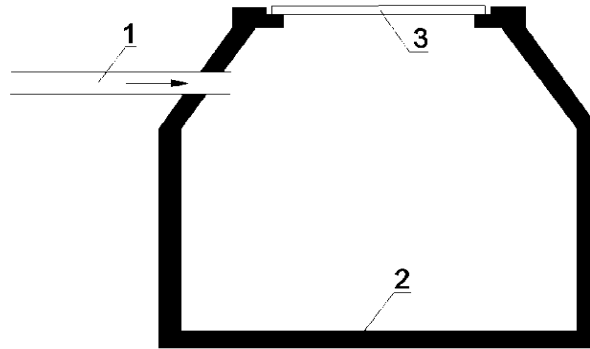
Rezervor subteran din beton armat monolit sau prefabricat
